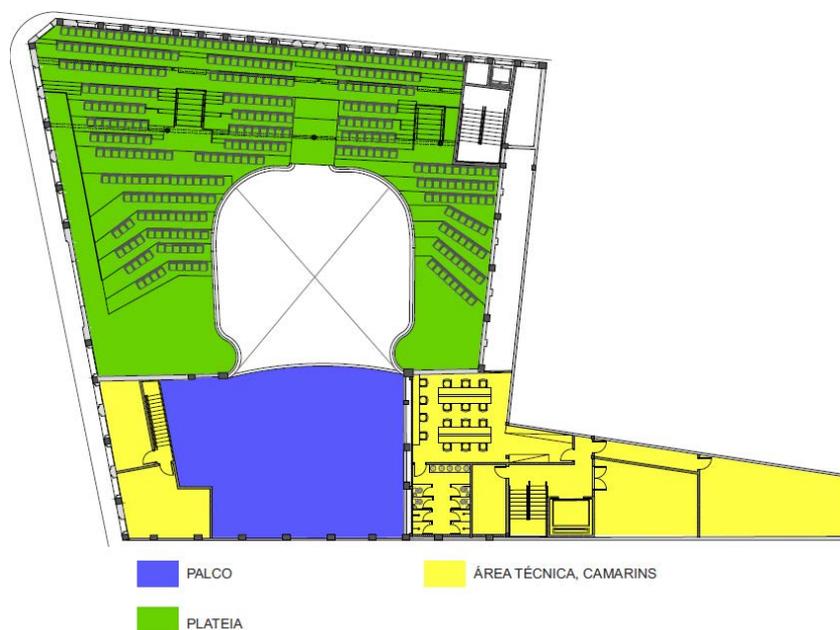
Projeto de restauração e requalificação. Planta baixa do nível da plateia. Acessos pelo foyer original e também por antecâmara proposta.
